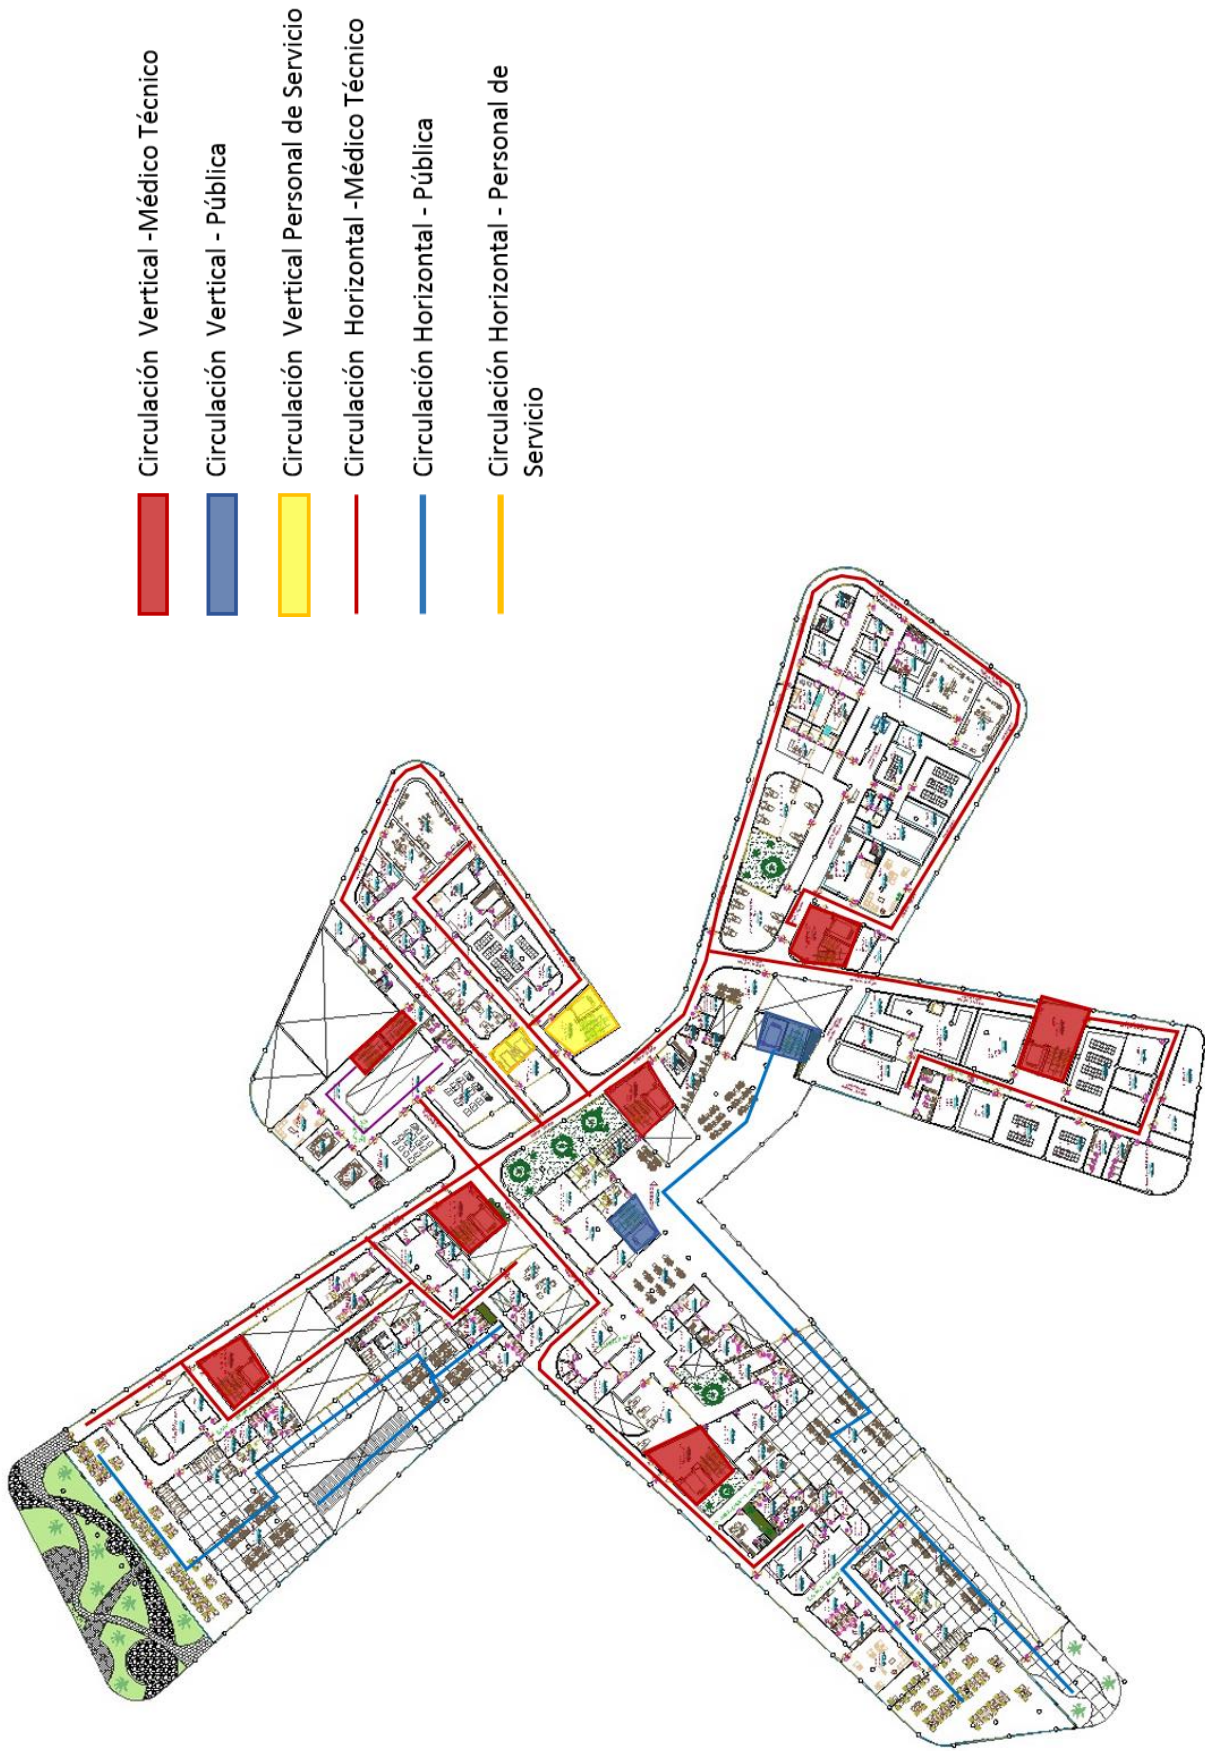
Circulación de Segunda Planta de la Propuesta Arquitectónica.
